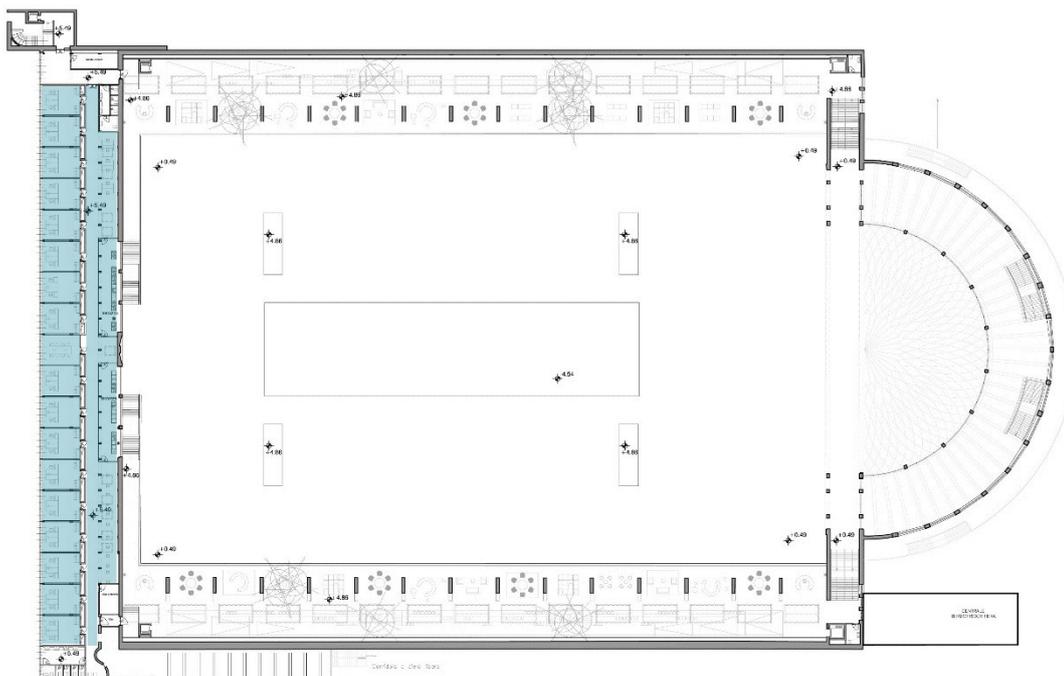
Pianta del piano primo con indicazione degli uffici del padiglione 2b con controsoffitto fonoassorbente.
